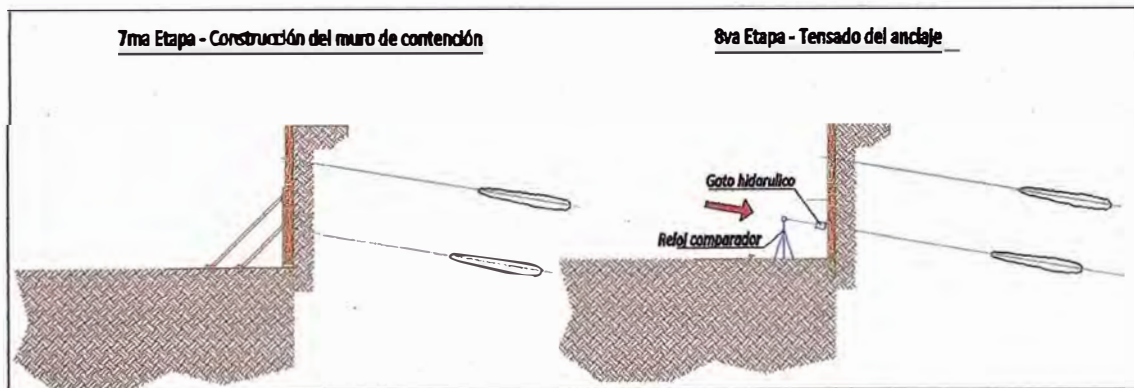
Secuencia de construcción del muro y tensado del anclaje
